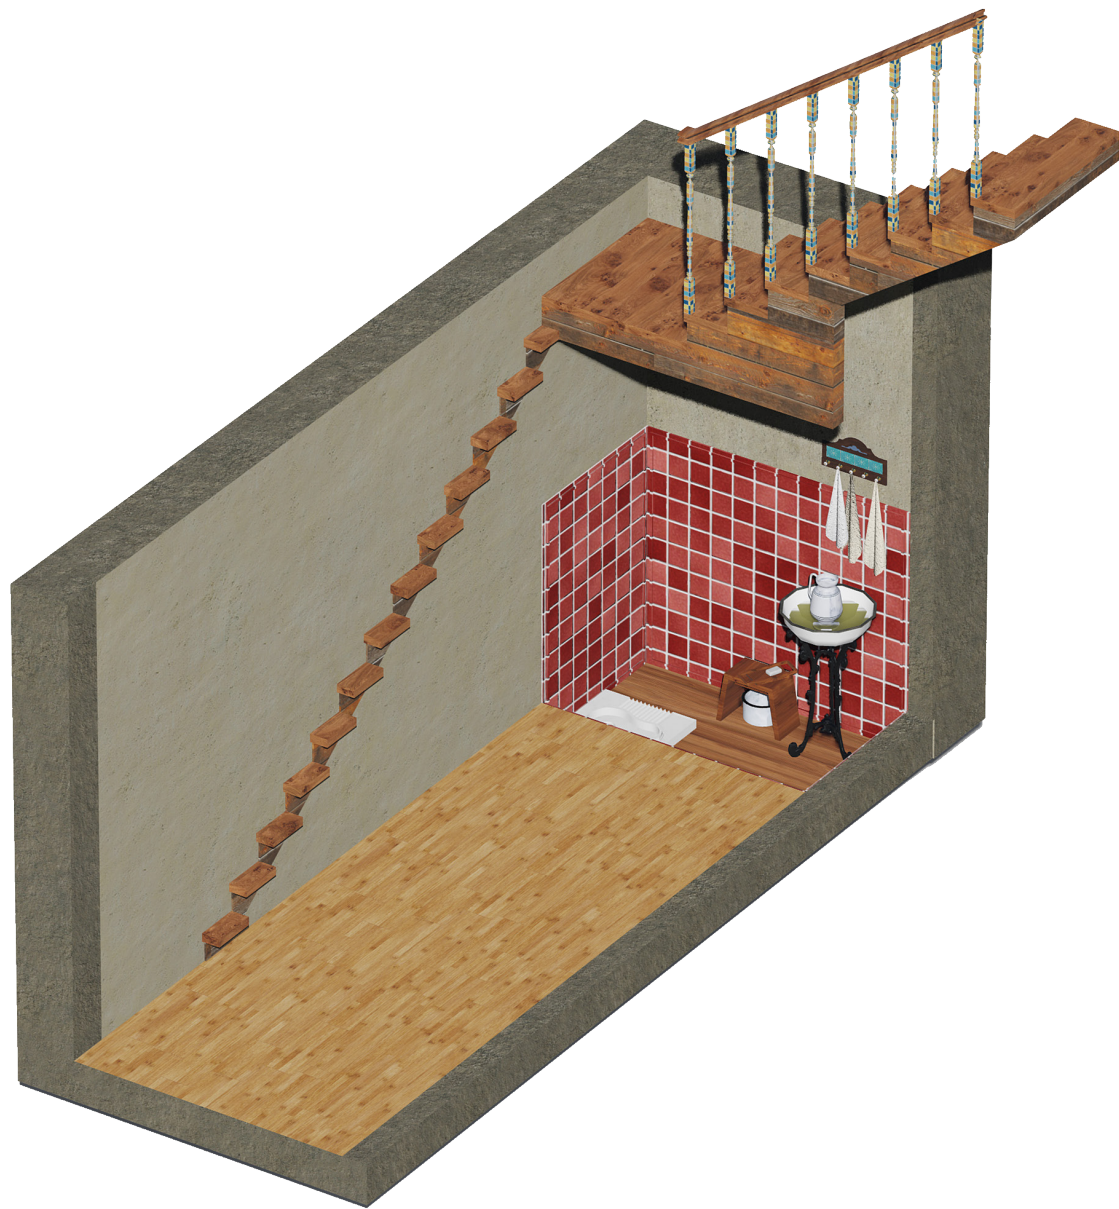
Axonometría Vivienda Rodríguez Planta Baja
